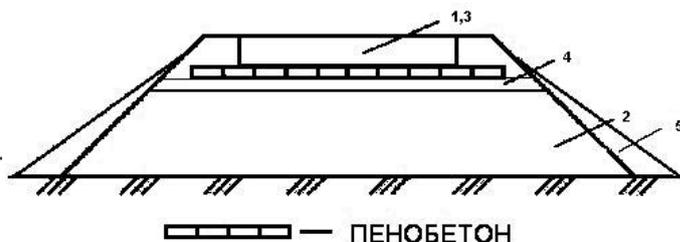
Схема дорожного полотна с использованием пенобетона непосредственно под дорожной одеждой, 1 – дорожная одежда, 2 – грунт насыпи, 3 – защитный слой, 4 – выравнивающий слой, 5 – присыпка
